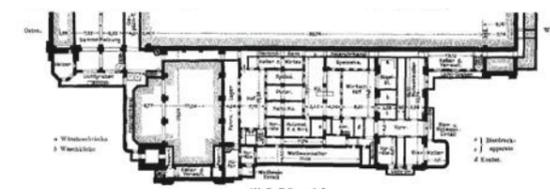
Grundrisse des Keller- und Erdgeschosses des Wiesbadener Hauptbahnhofes, 1908
